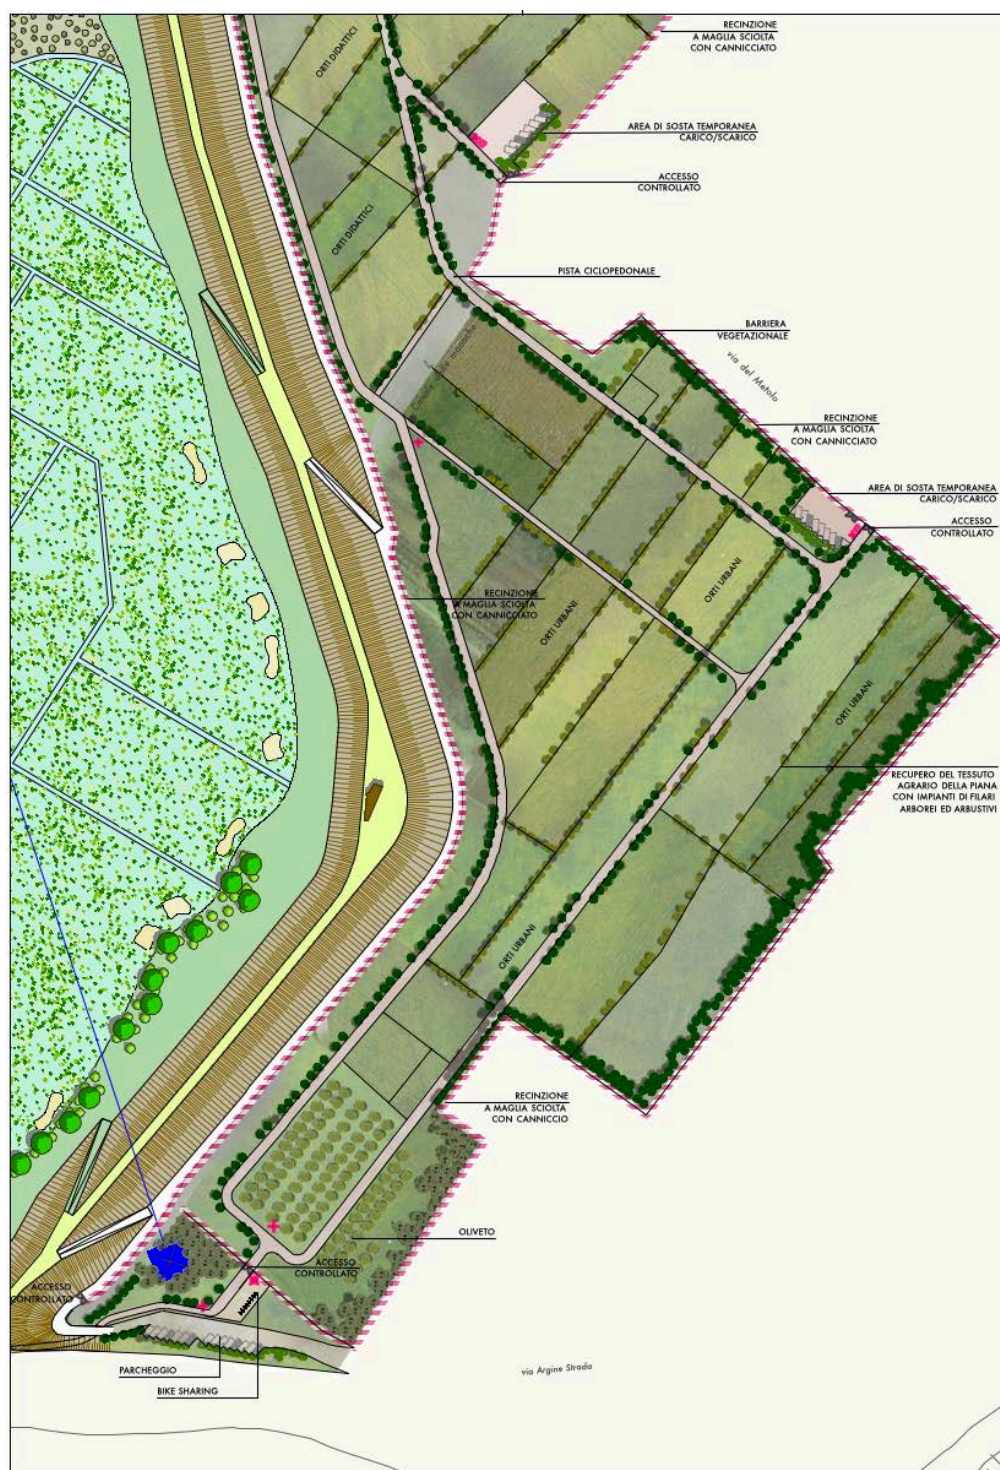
Planimetria dell'area "Orti Urbani"
